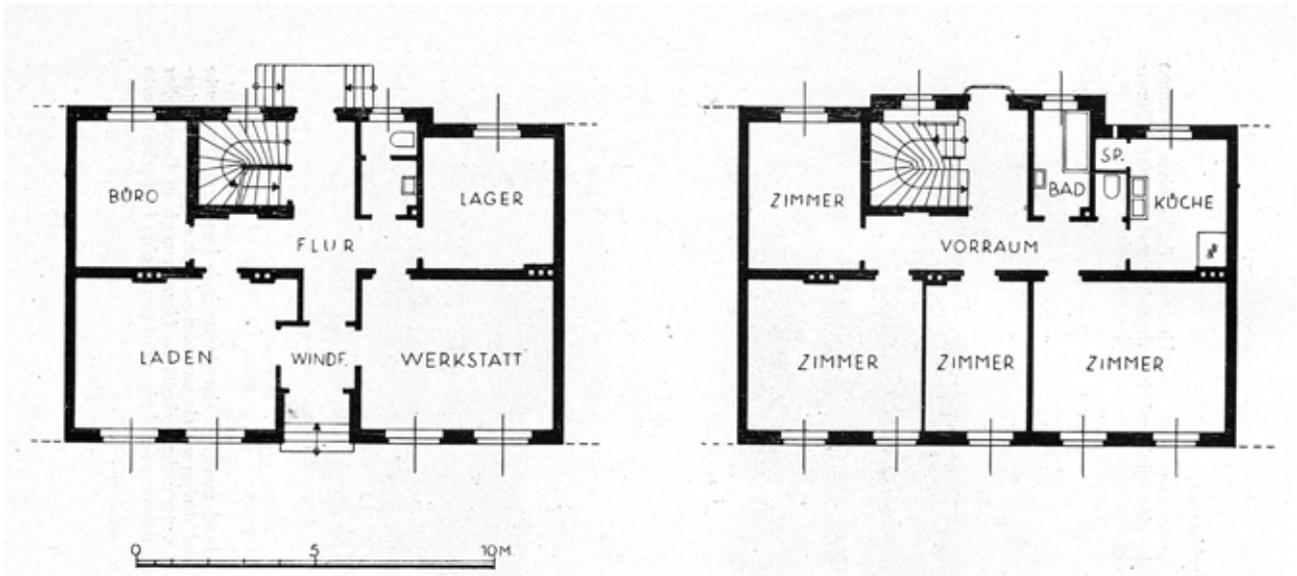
Erdgeschoß und I. Stock eines Hauses an der Hauptstraße. Haus eines Gewerbetreibenden mit Werkstatt, Laden, Büro und Magazin. Entwurf Karl Rebhahn.
